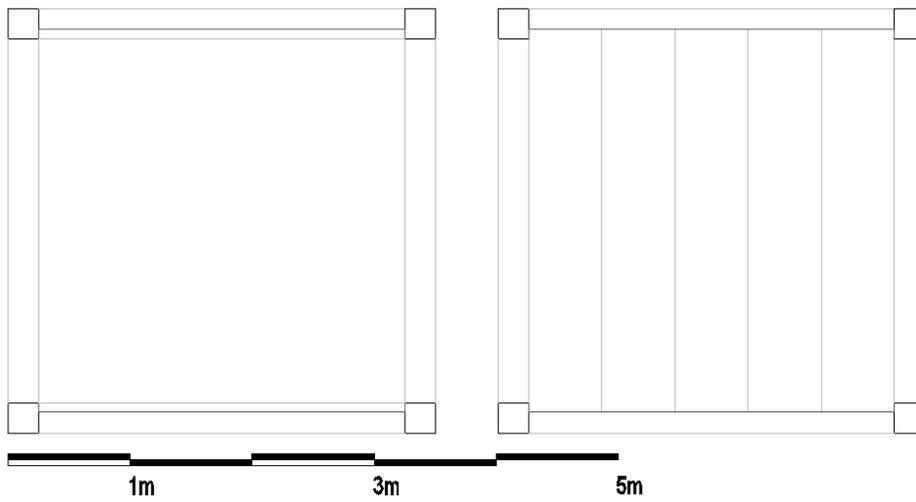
Ubicación de paneles de entrapiso dentro de elementos estructurales.
